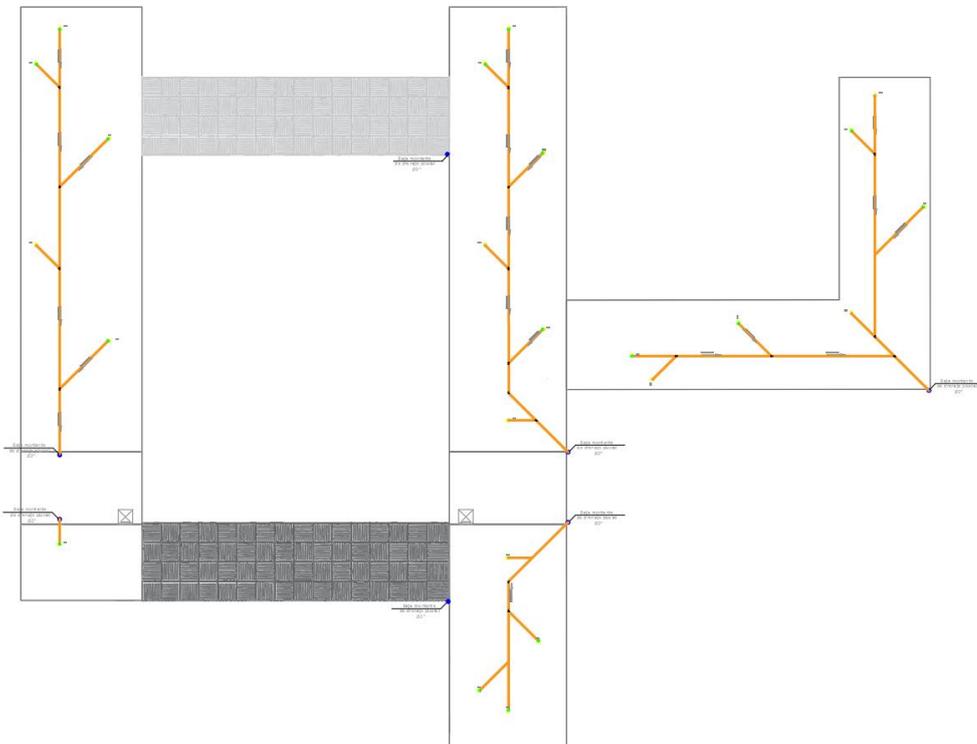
DRENAJE PLUVIAL - TECHO
